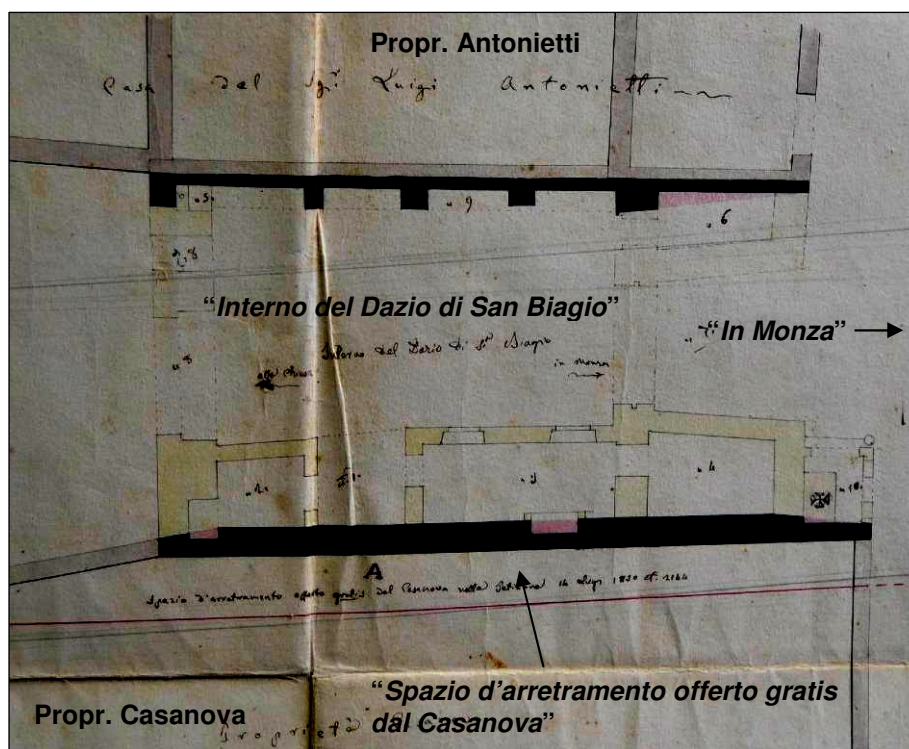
Particolare della planimetria del 'Dazio di San Biagio', 1844<sup>29</sup>.
